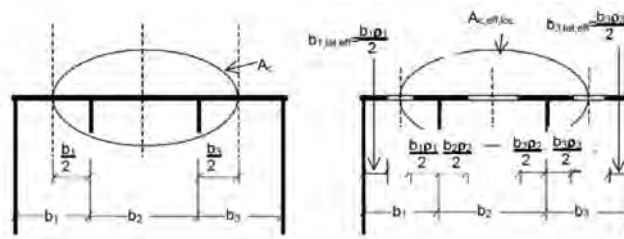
Lastra irrigidita uniformemente compressa
